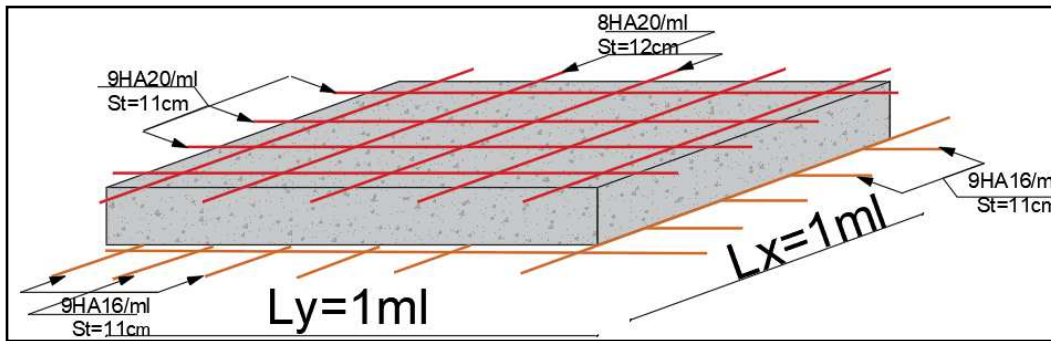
Schéma 3D de ferrailage du radier pour 1 ml.
